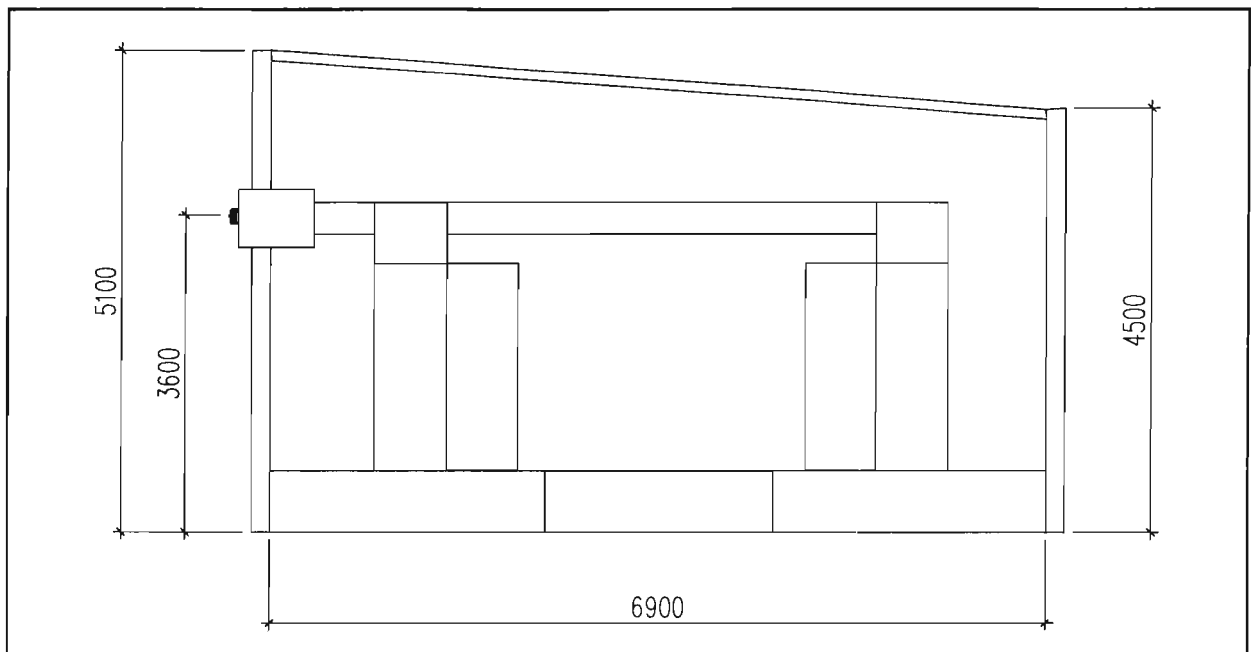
Поперечный разрез КРУ в БМЗ
